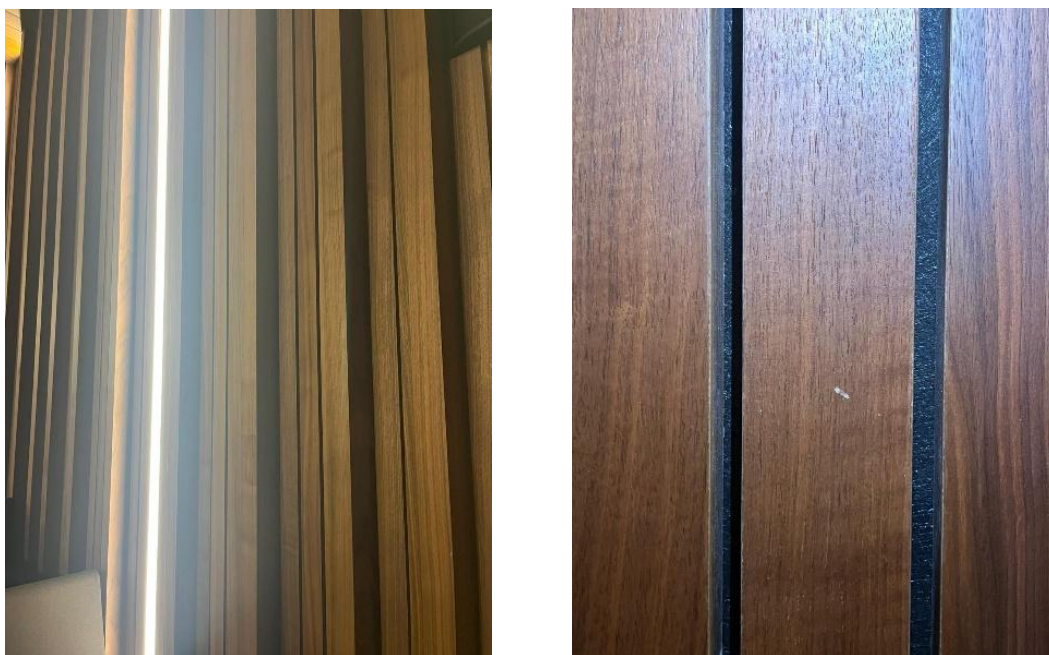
Revestimento das paredes laterais da plateia com painéis de madeira (esquerda); detalhe do material fonoabsorvente aplicado entre os painéis (direita). [fotos da autora]
